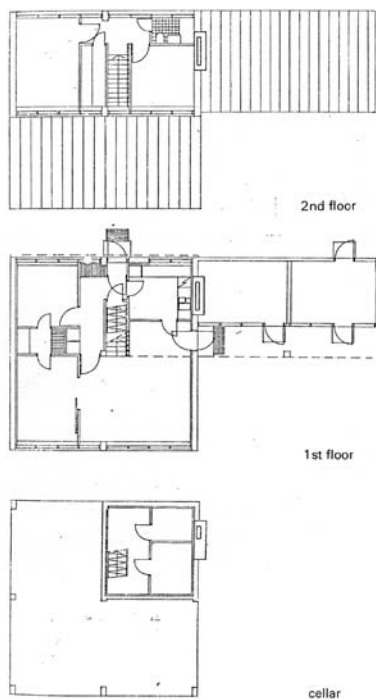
Ketju Row House 平面図 (出典 Heikki von Hertzen and Paul D. Spreiregen: Building a new town: Finland's new garden city, Tapiola, Cambridge, Mass., MIT Press, 1971、以下平面図同)
